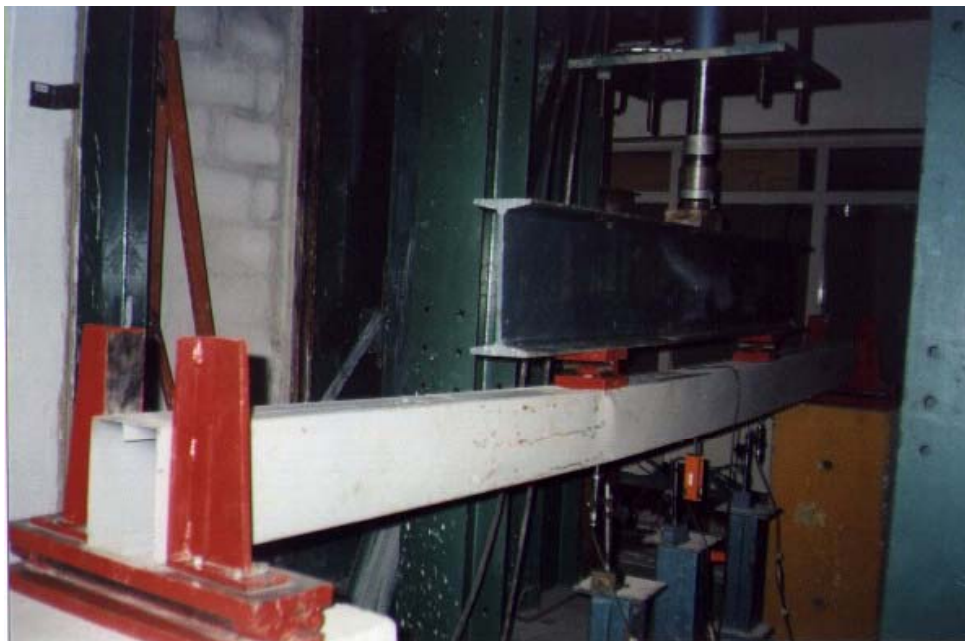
Esquema do ensaio, mostrando detalhe do sistema de apoios e da instrumentação utilizada.
